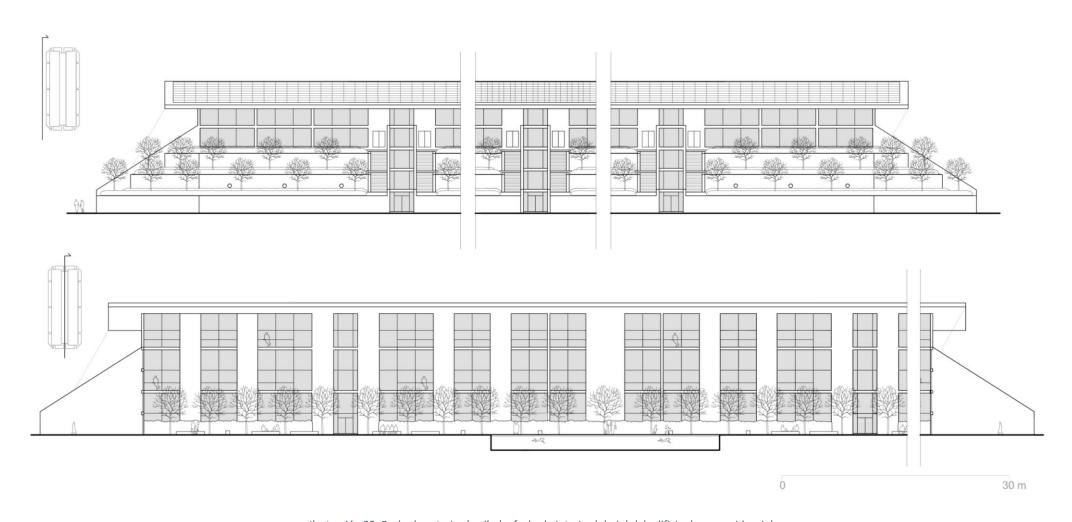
Fachada exterior (arriba) y fachada interior (abajo) del edificio de uso residencial
